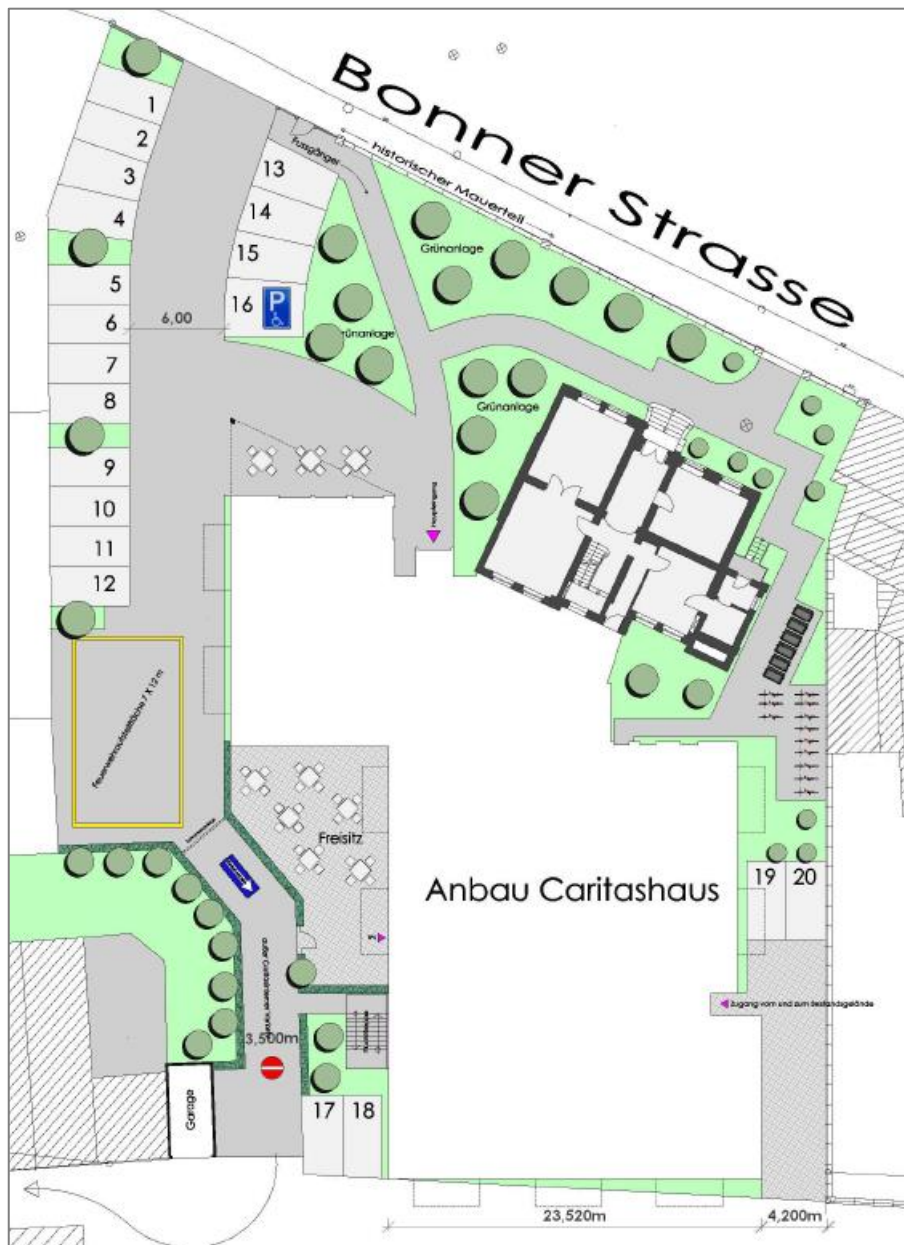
Vorhabenplan mit Außenanlagen (Darstellung Grundriss EG)
